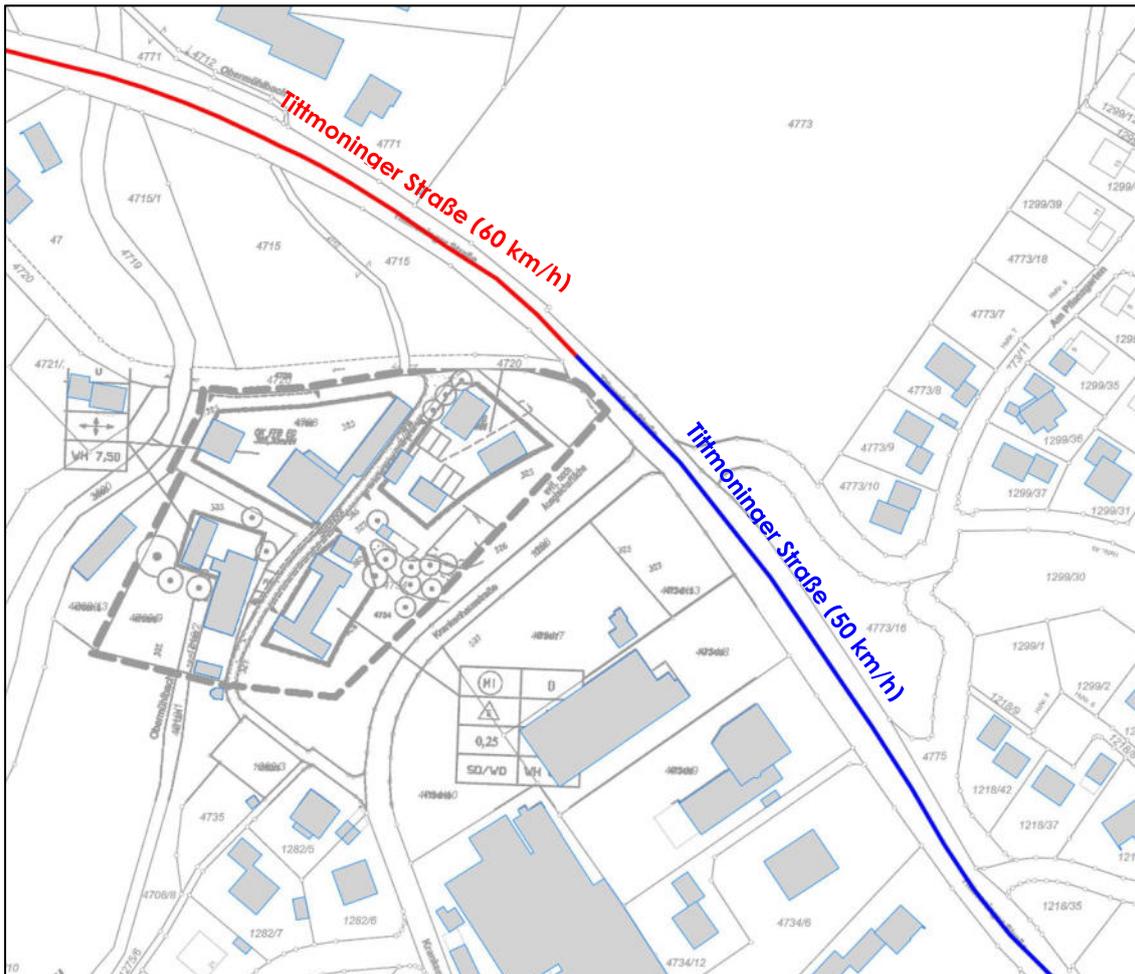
Lageplan mit Darstellung der relevanten Straßenabschnitte
